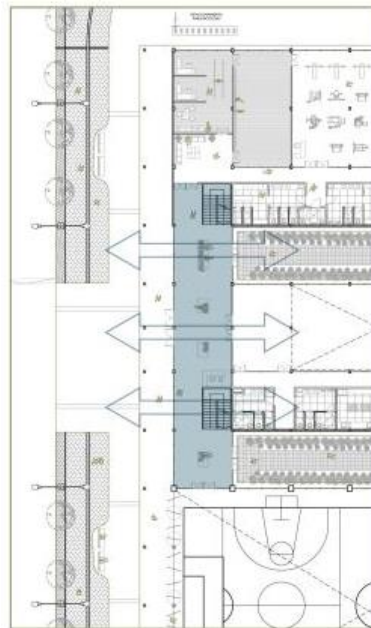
Planta baja conexiones. Fuente: ilustraciones propias
